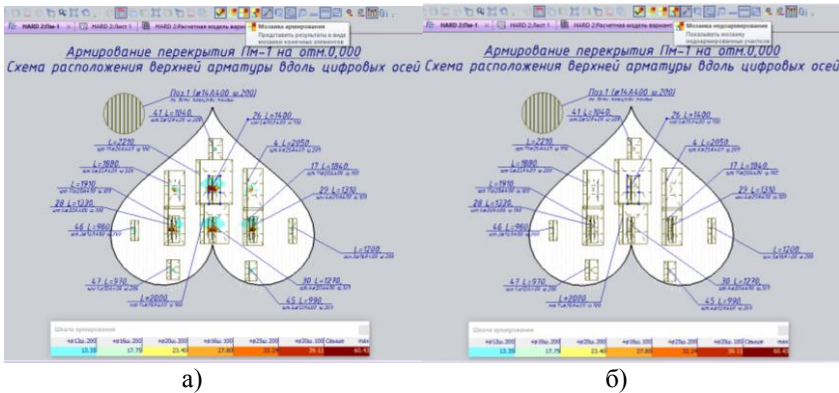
Схема розташування арматури плити перекриття на фоні мозаїки: а) армування; б) недоармування
